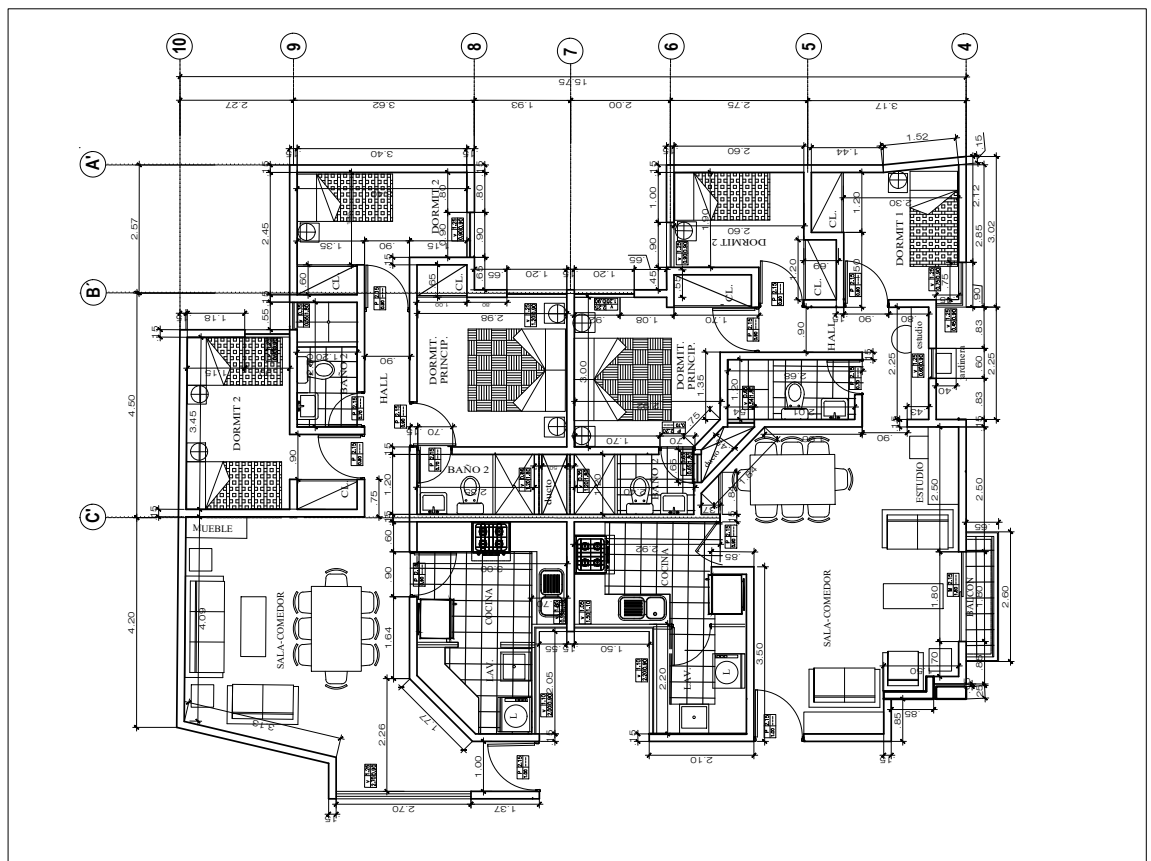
Vista en planta de la arquitectura del Bloque B
